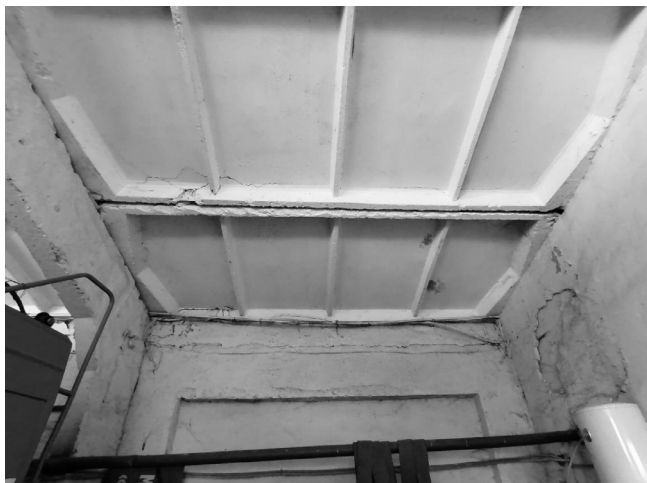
Сколы и трещины защитного слоя плит перекрытия.
